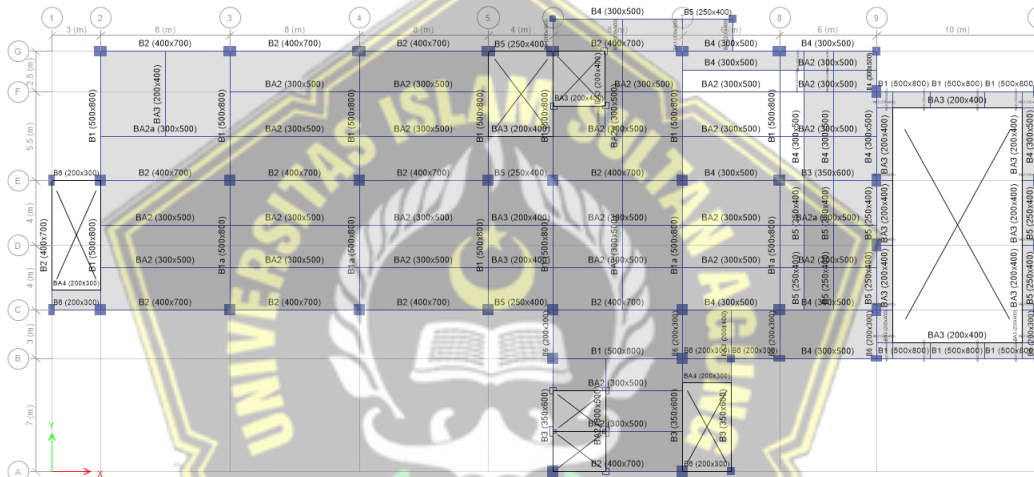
Denah Lantai 2 (EL. +4.00)
